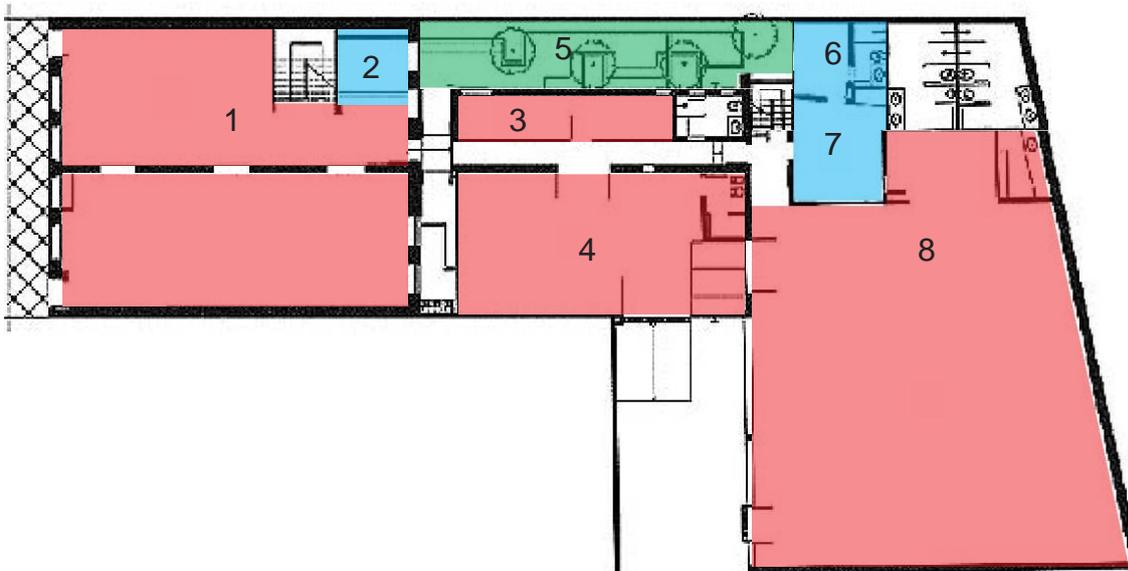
PLANTA PAVIMENTO TÉRREO – SEM ESCALA
